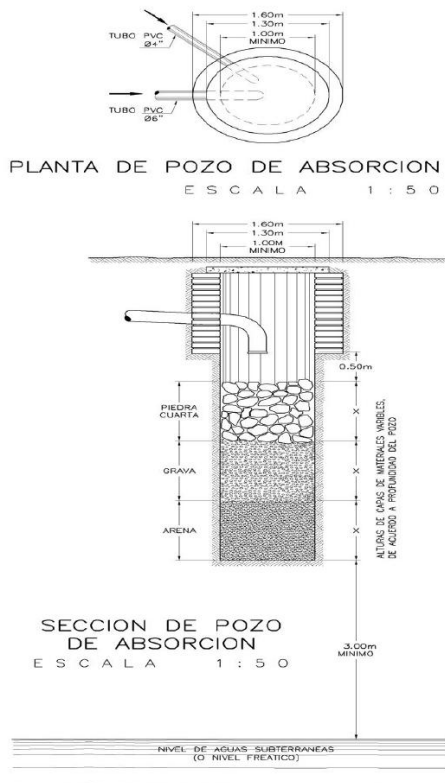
Vista en planta y sección de pozo de absorción.
